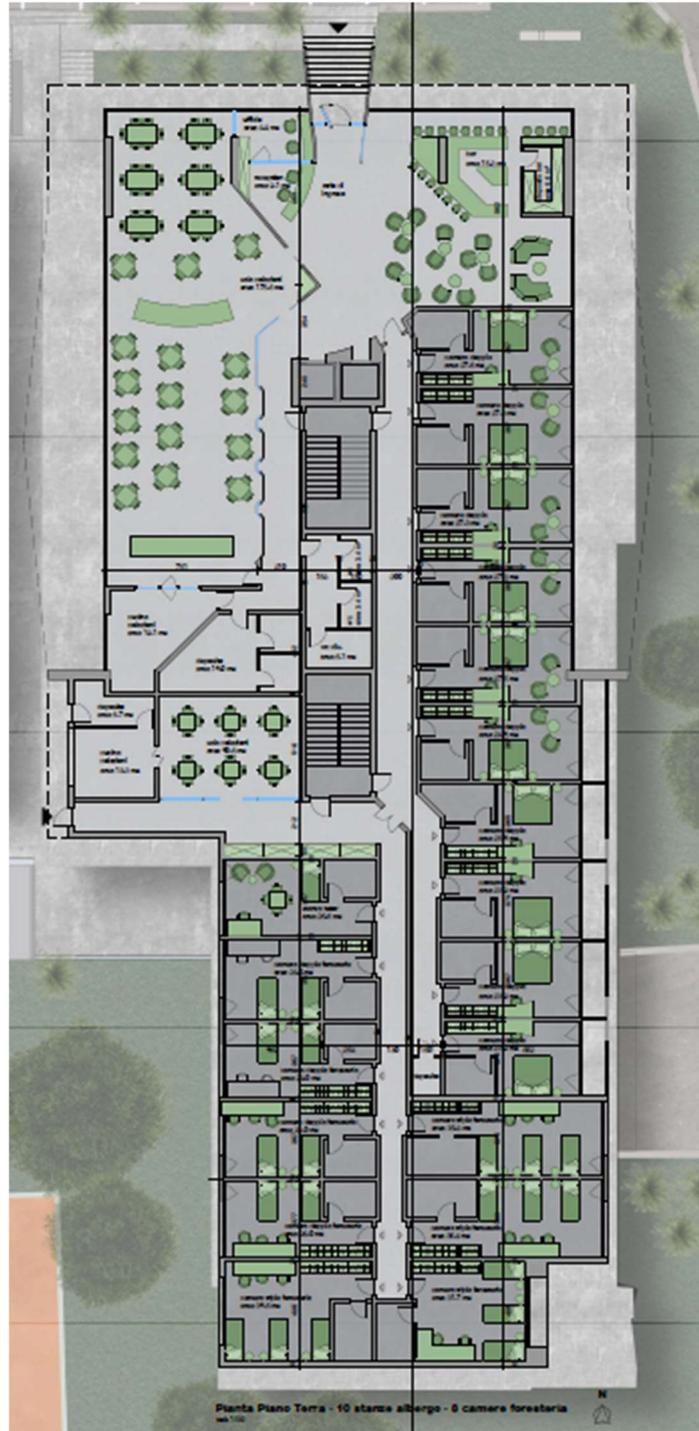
Pianta piano terreno del fabbricato alberghiero e della foresteria
